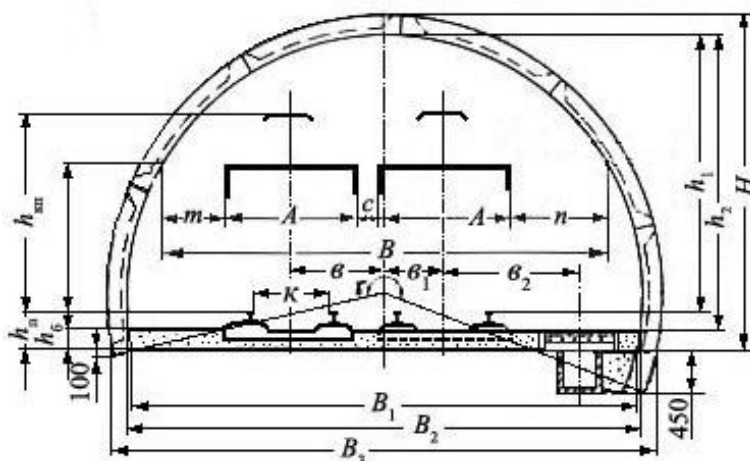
Поперечные сечения двухпутевой выработки со сборной железобетонной гладкостенной крепью
